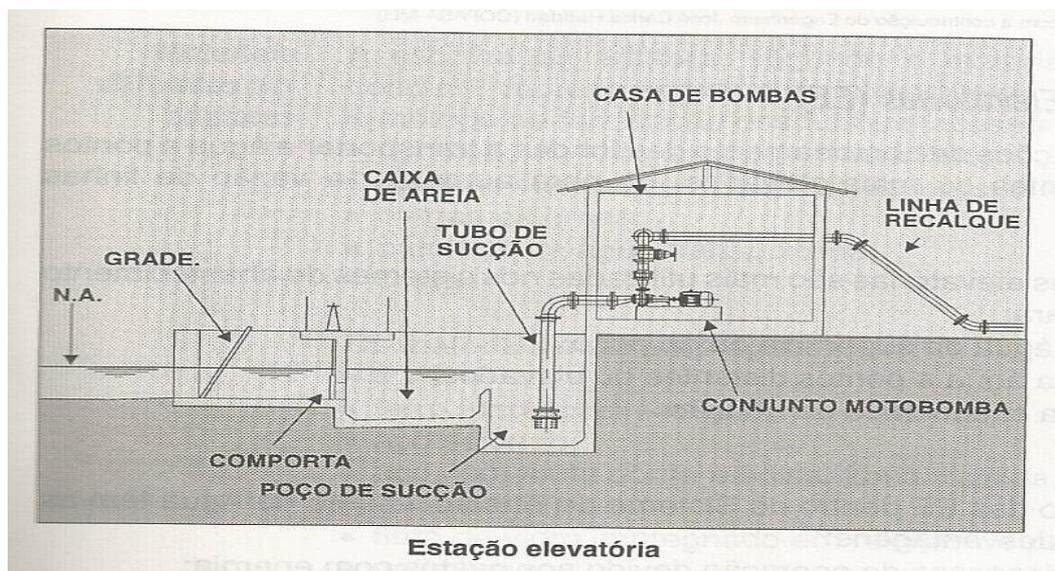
Estação elevatória. (Fonte: BARROS, 1995, p.81)
